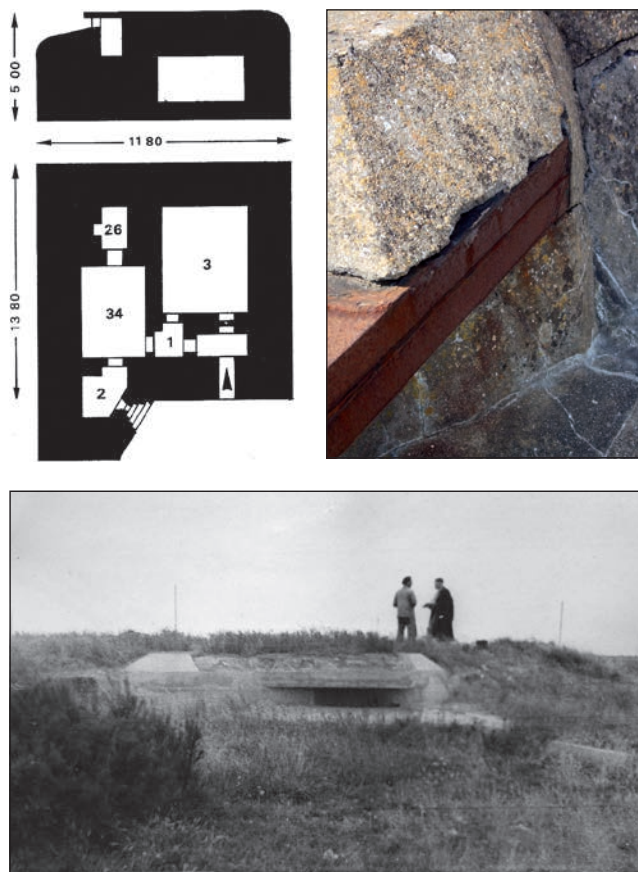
Imágenes del puesto de observación 627. 26a: plano de dicha construcción (Rudi Rolf). 26b: fotografía de *Schwalbe* al poco de finalizar el conflicto, donde se muestra en primer plano la zona de observación protegida por las placas blindadas (SHM Rochefort 1W 1849). 26c: Detalle de la protección blindada formada por la unión de dos placas de diez centímetros de espesor cada una, pertenecientes a la cercana batería de Saint-Denis (fotografía autor).
